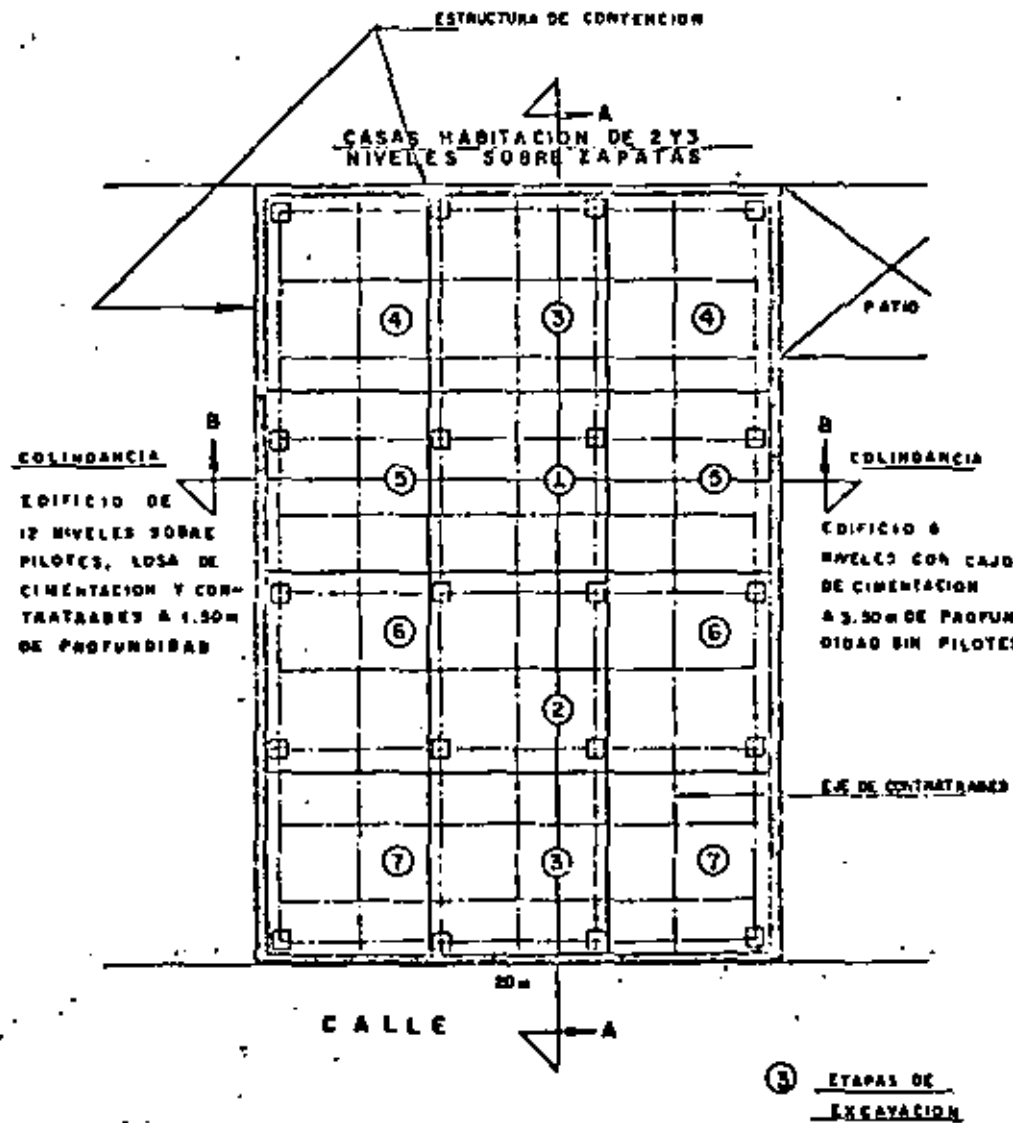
ETAPAS DE EXCAVACION Y PROCESO CONSTRUCTIVO
